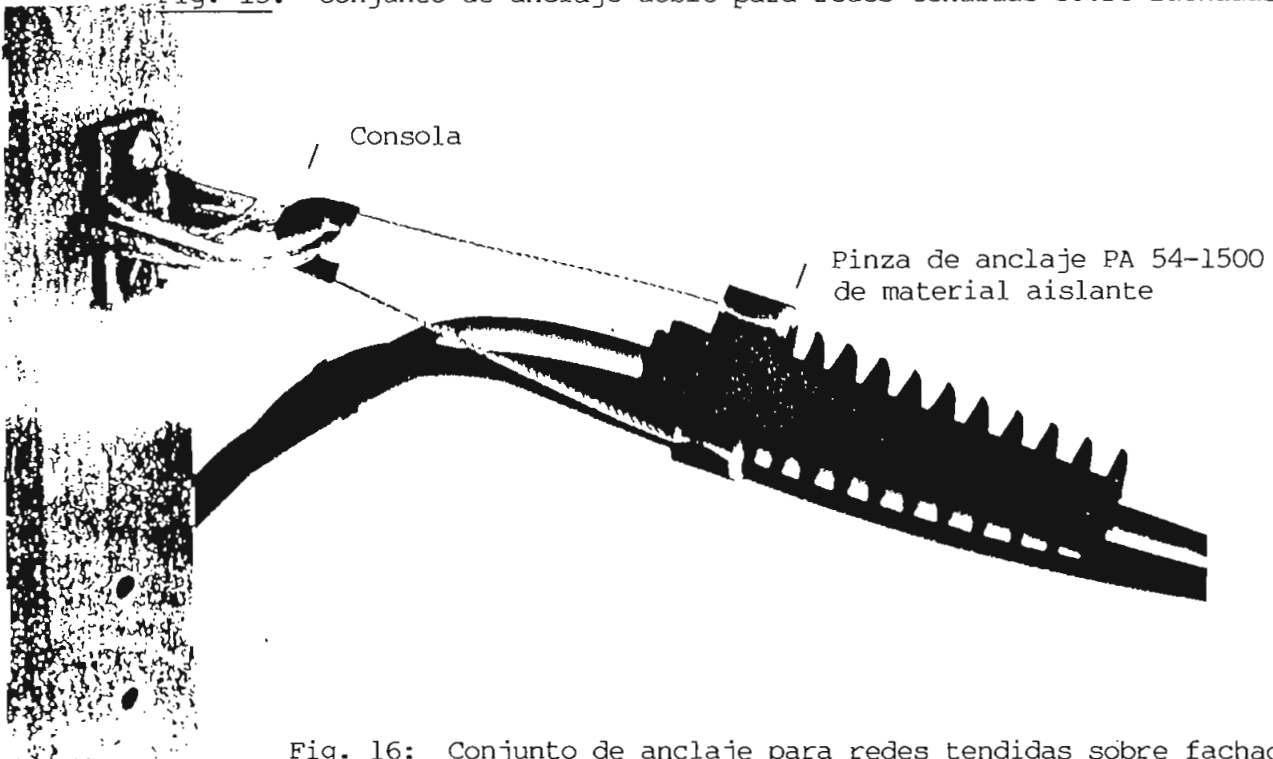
Conjunto de anclaje para redes tendidas sobre fachadas
